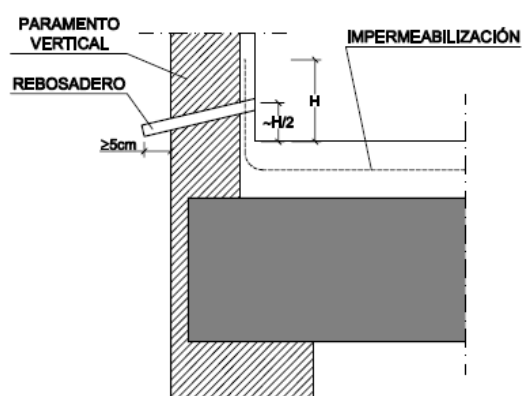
Rebosadero en cubierta plana¹.
